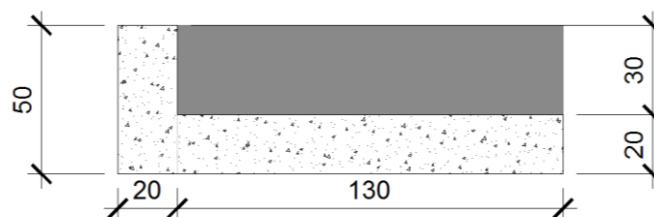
Seção Transversal da viga pré-moldada - Fase Construtiva
